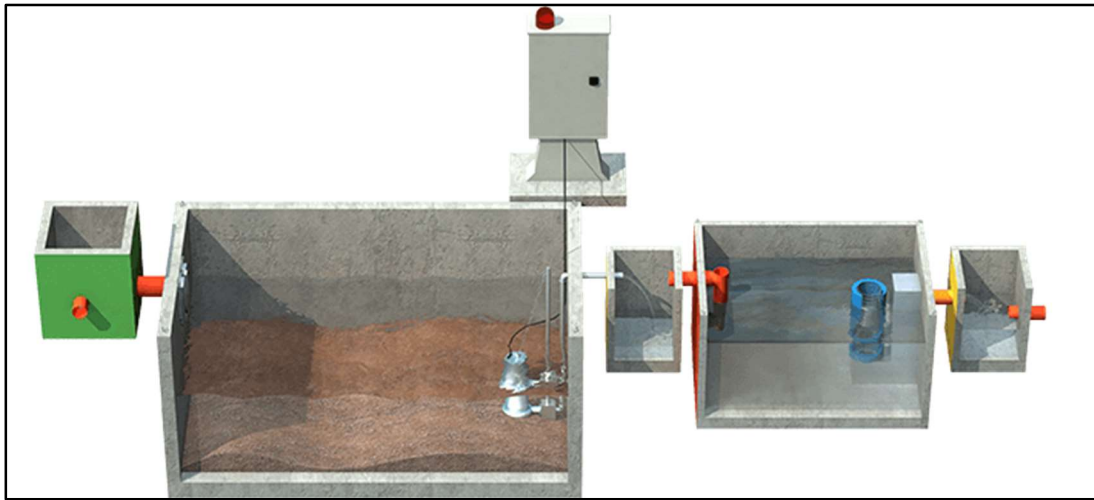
Schema tipologico di un impianto di raccolta e trattamento delle acque di prima pioggia. Edil impianti S.p.A.
